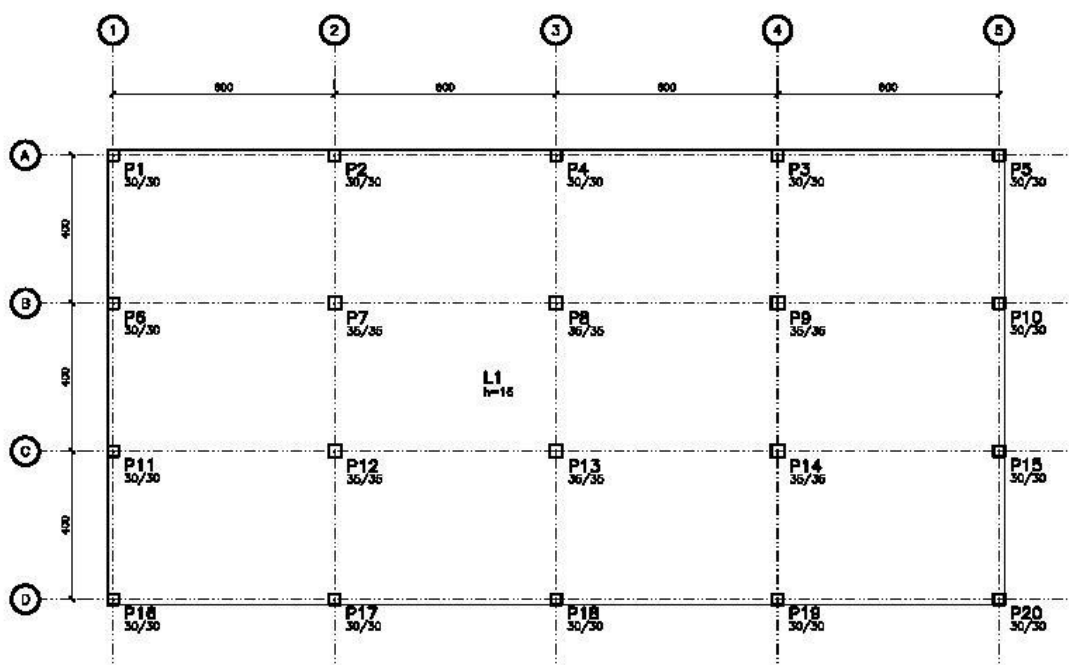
Planta do pavimento em malha retangular (tipo A)
